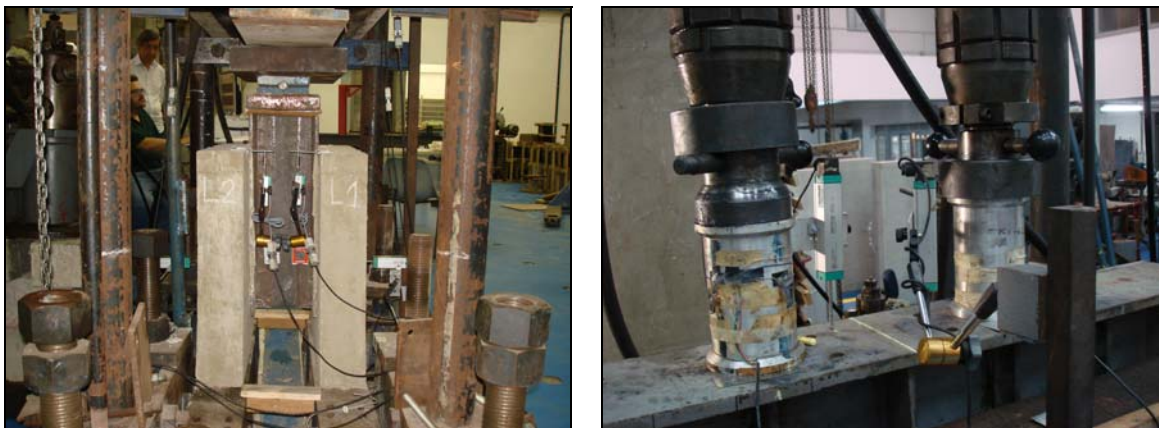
RDL's verticais no perfil / laje e RDL's na viga de transição, LEM.
